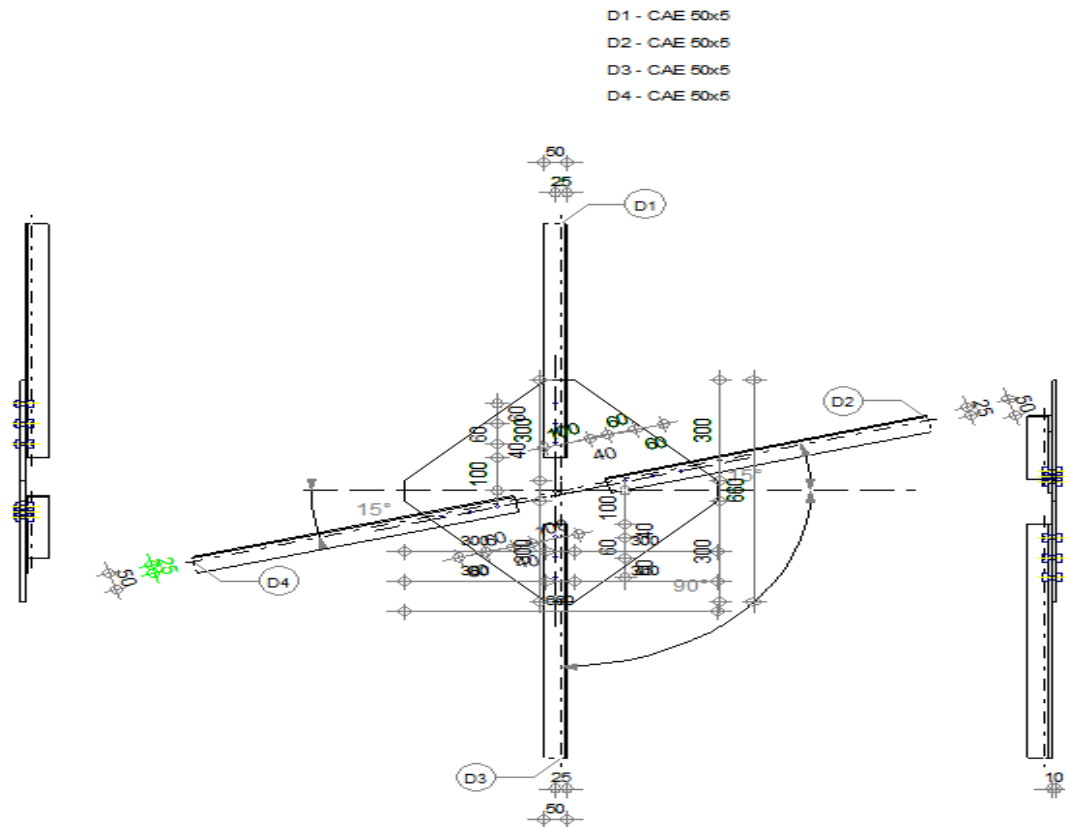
vue en plan de l'assemblage de la diagonale de la poutre ou vent.
